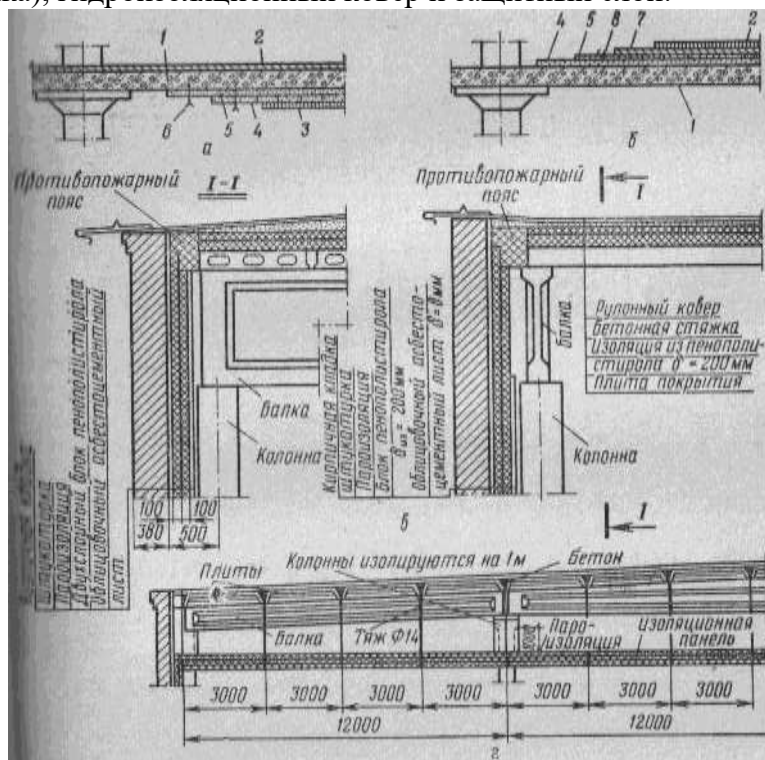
Изоляционные конструкции перекрытий и покрытий:
